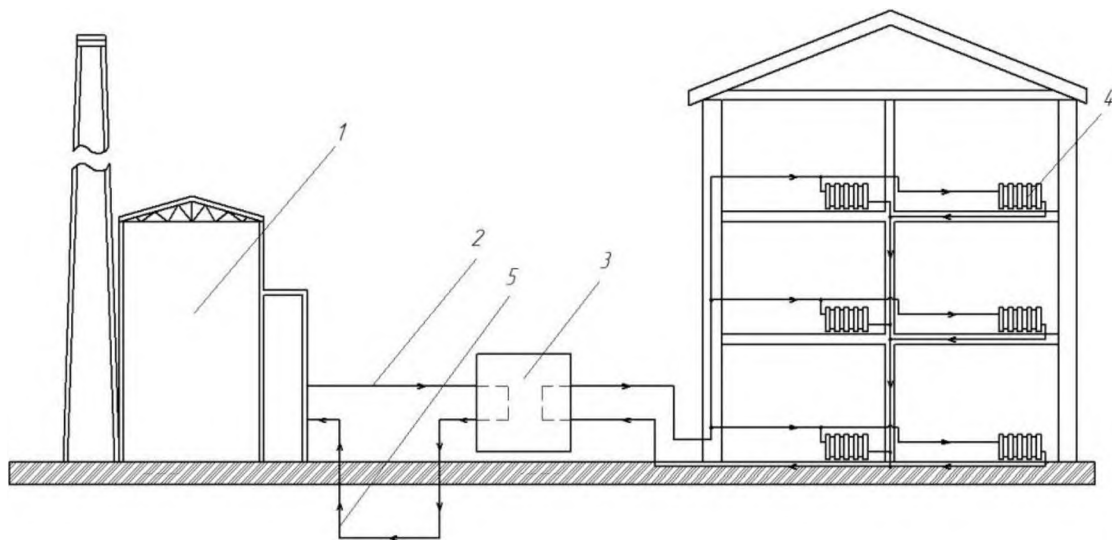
Каскадний опалювальний пристрій: 1 - котел, 2 - прямий трубопровід для подачі нагрітої води на опалення, 3 - теплонасосна установка, 4 - опалювальні прилади, 5 - зворотній трубопровід до котла.
